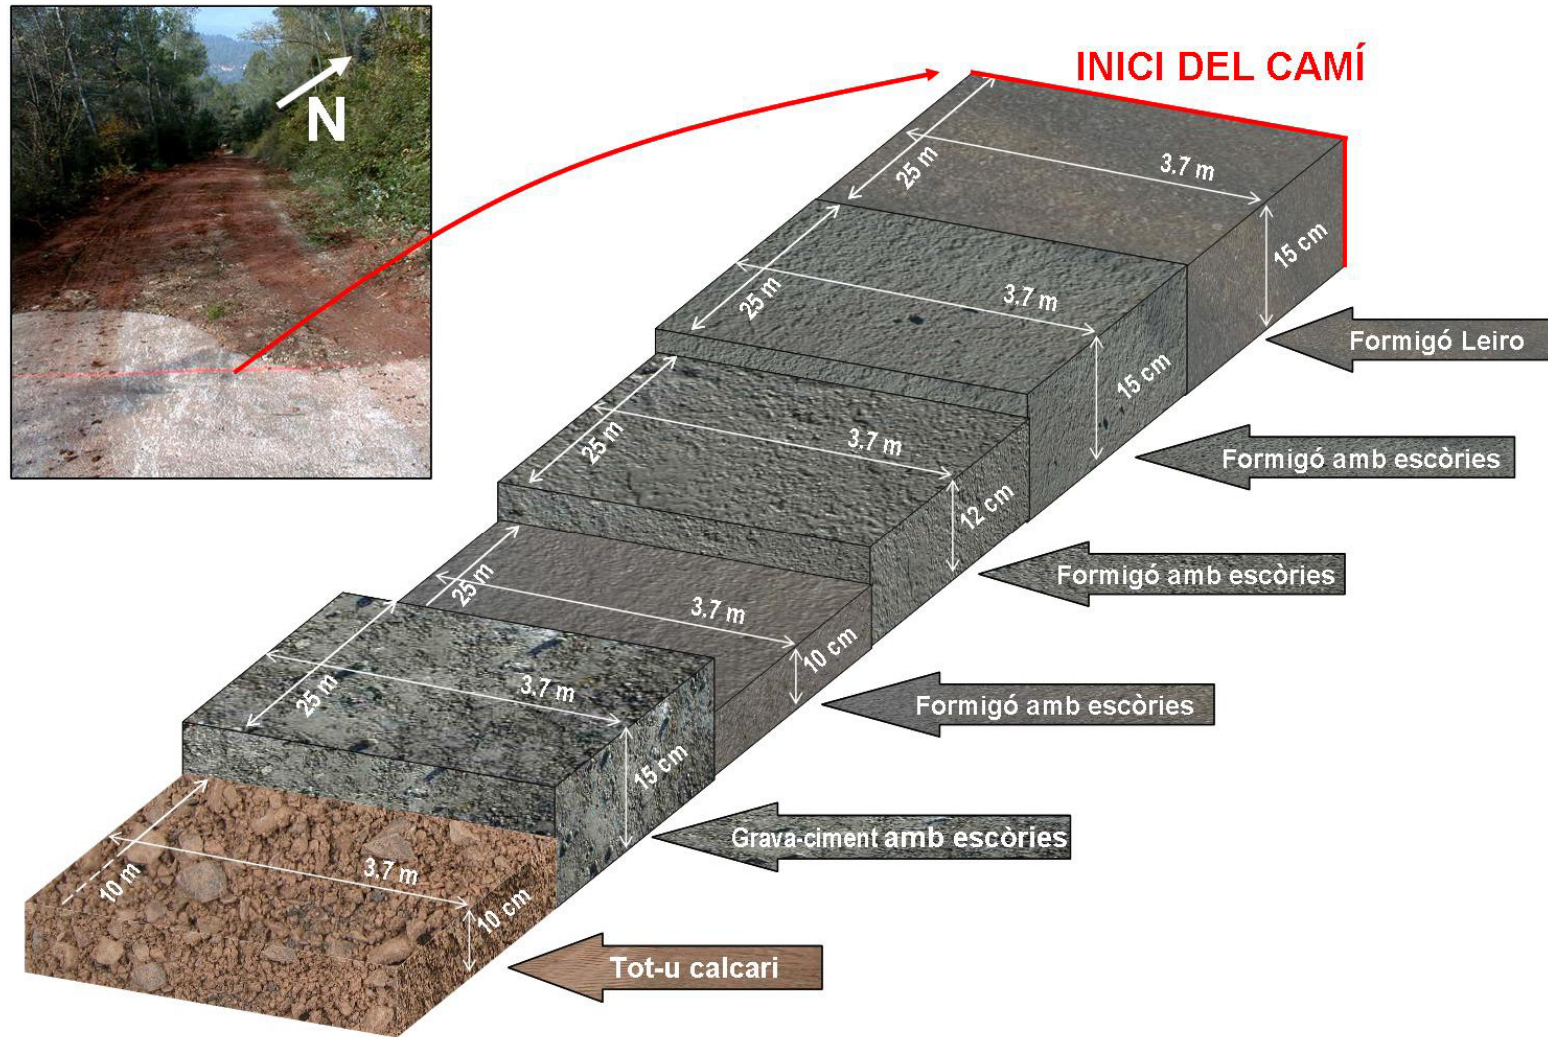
Solucions aplicades al tram de pavimentació contínua.
